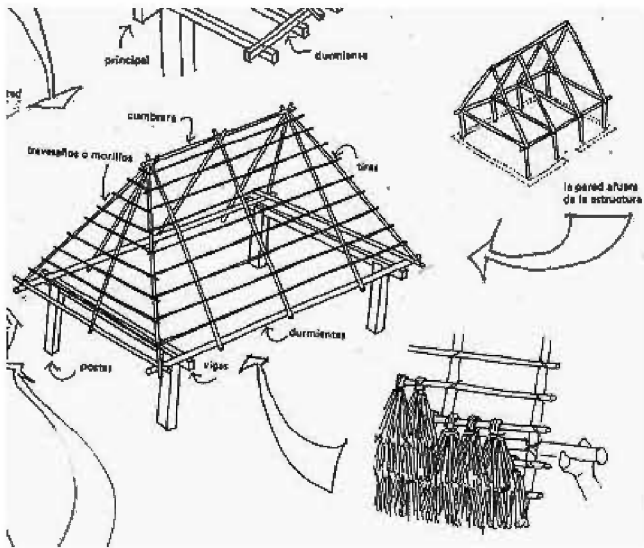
Tanchachín: Tipología de vivienda y materiales constructivos. Fuente: gráfico de los autores.
